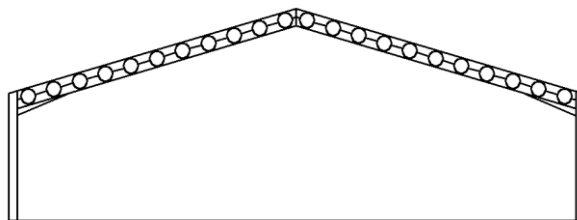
Pórtico simples com viga castelada ou celular
